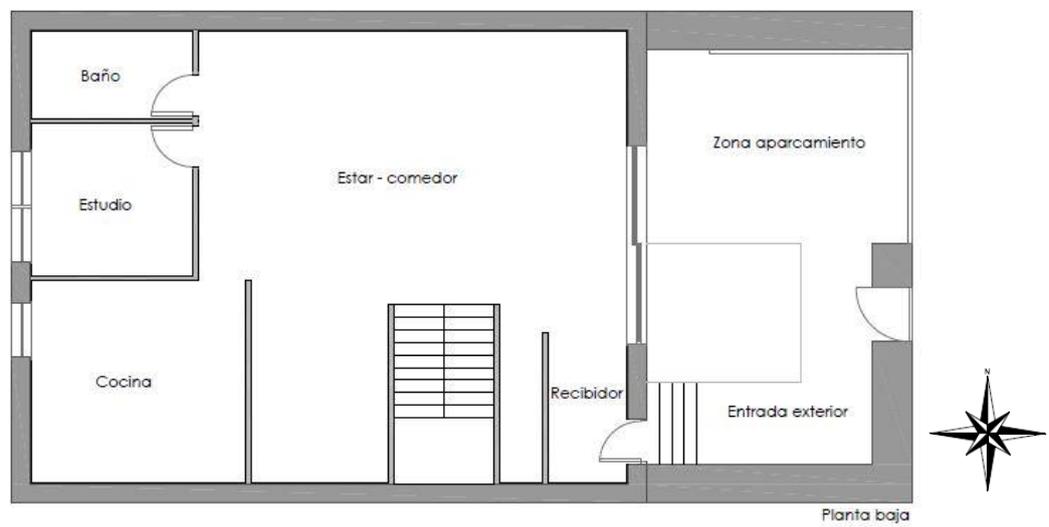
Planta baja. Fuente: Elaboración propia.
